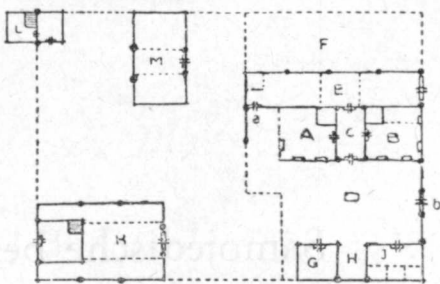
Grundriss eines weissrus-sischen gehöftes. Nach Nikiforowskij.
